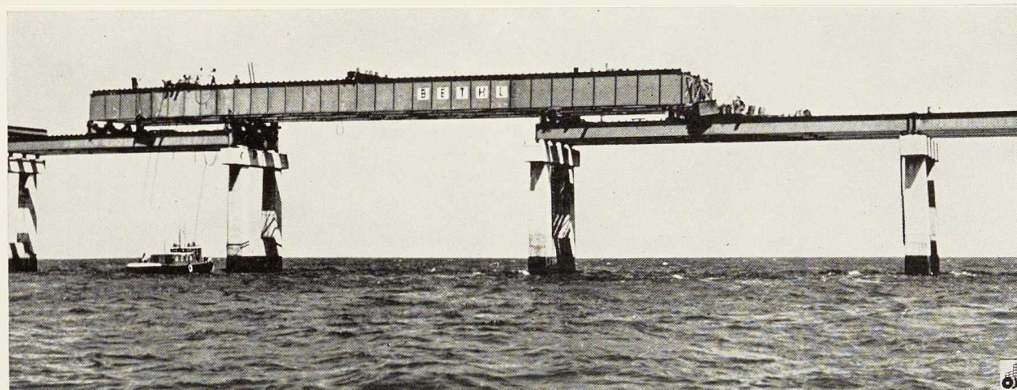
Montage d'une travée de 65,60 m en poutres à âme pleine.
